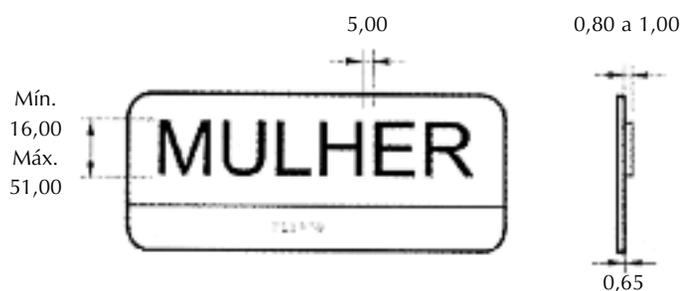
Sinalização tátil - vista superior e corte (dimensões em mm)
